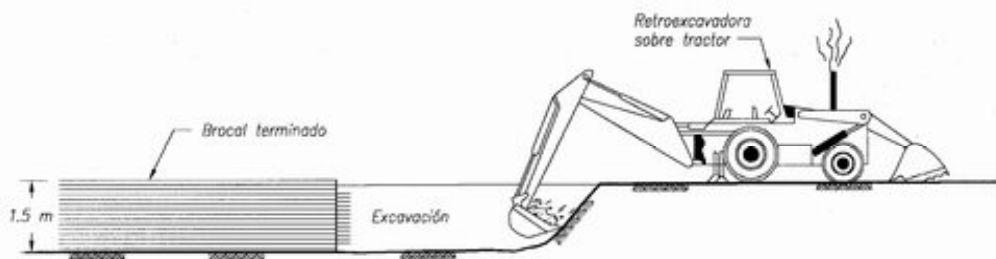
, Preexcavación para la construcción de brocales para muros milán en zonas sin interferencia
